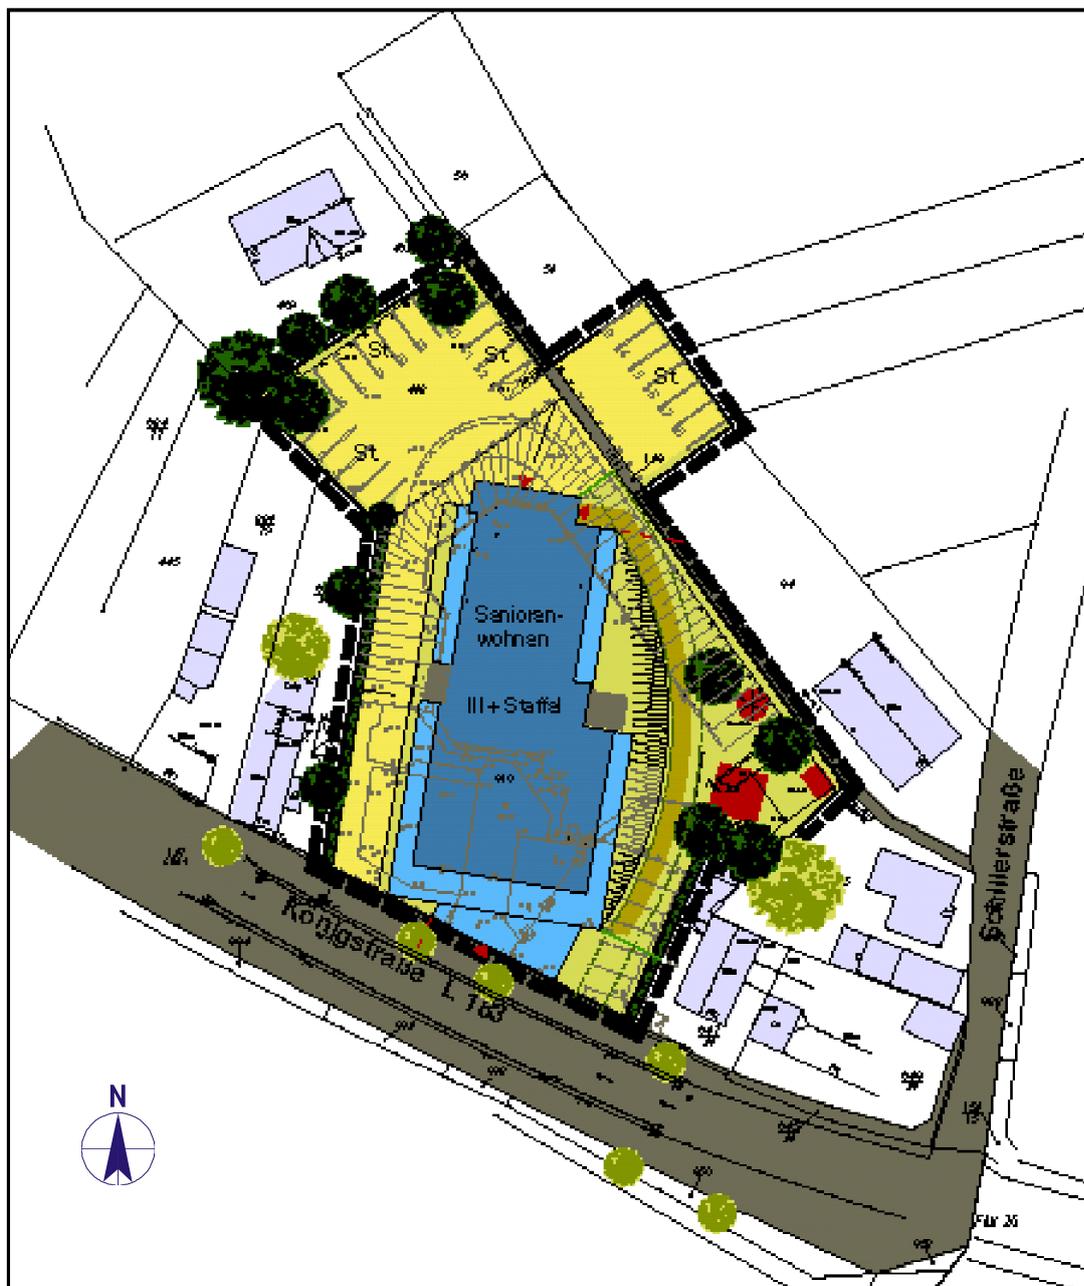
Lageplan des geplanten Seniorenstifts an der Königstraße 24 in Bornheim, Maßstab 1:800
